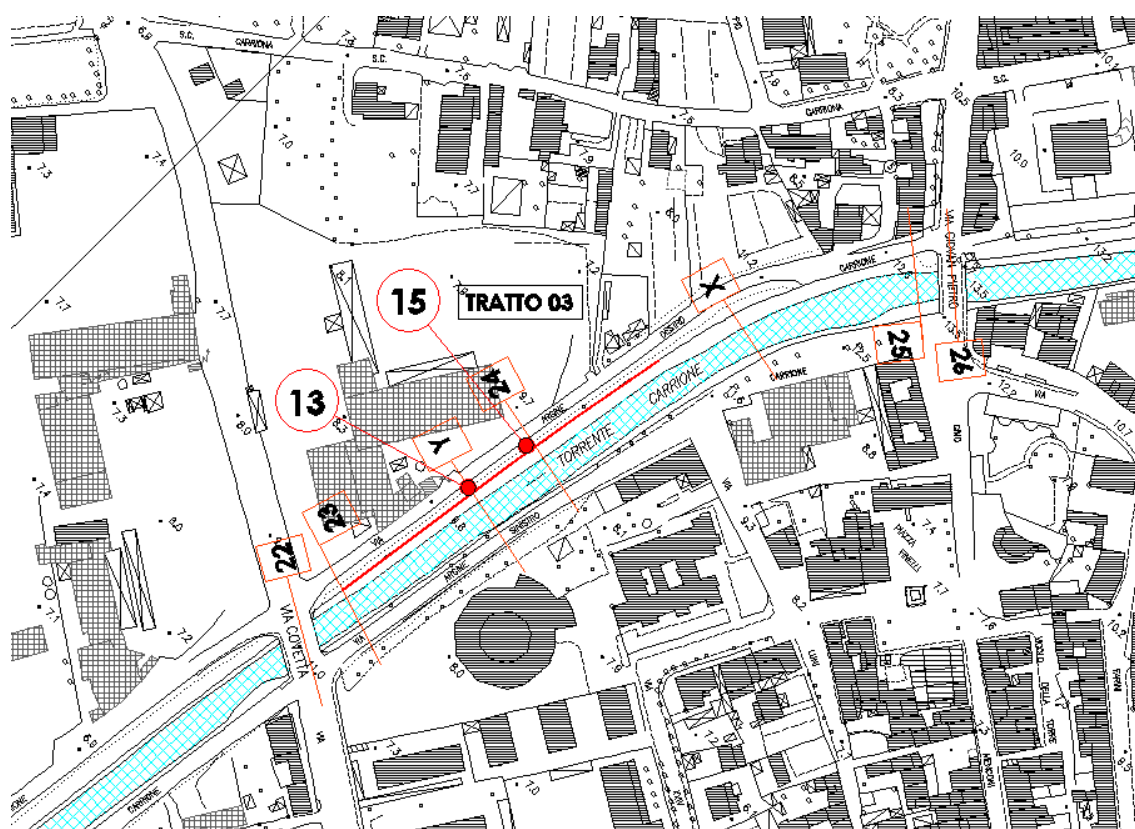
Inquadramento planimetrico – Tratto 03 – Sponda destra
